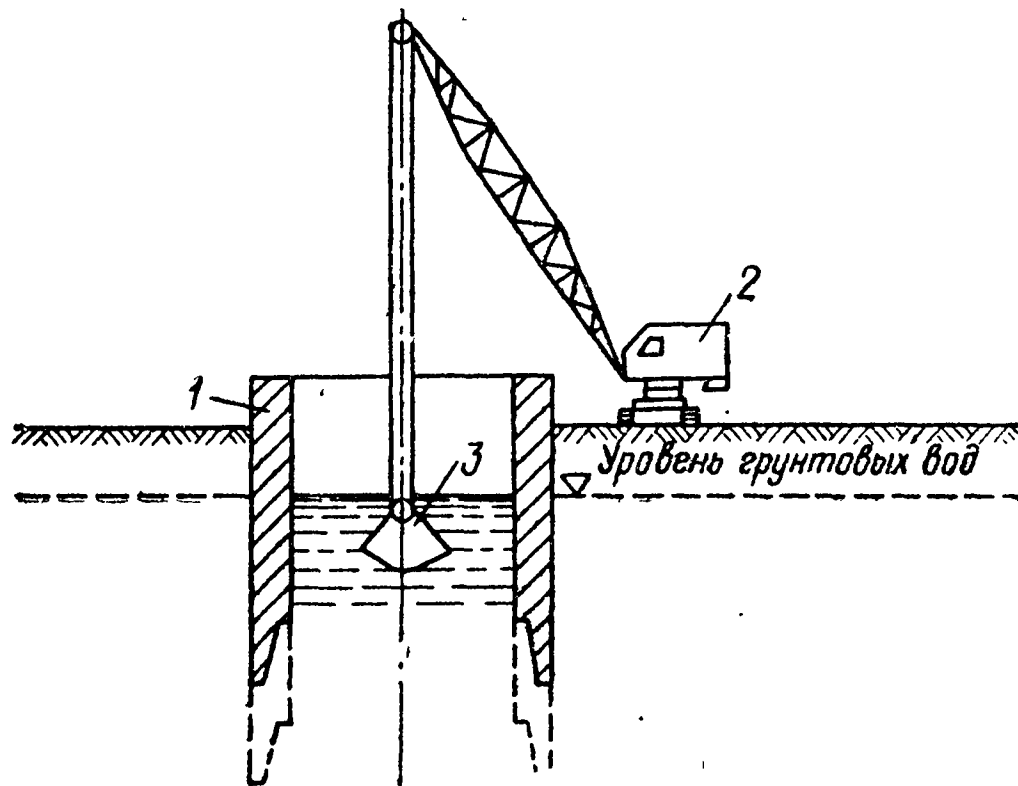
Схемы разработки грунта в колодце грейфером
